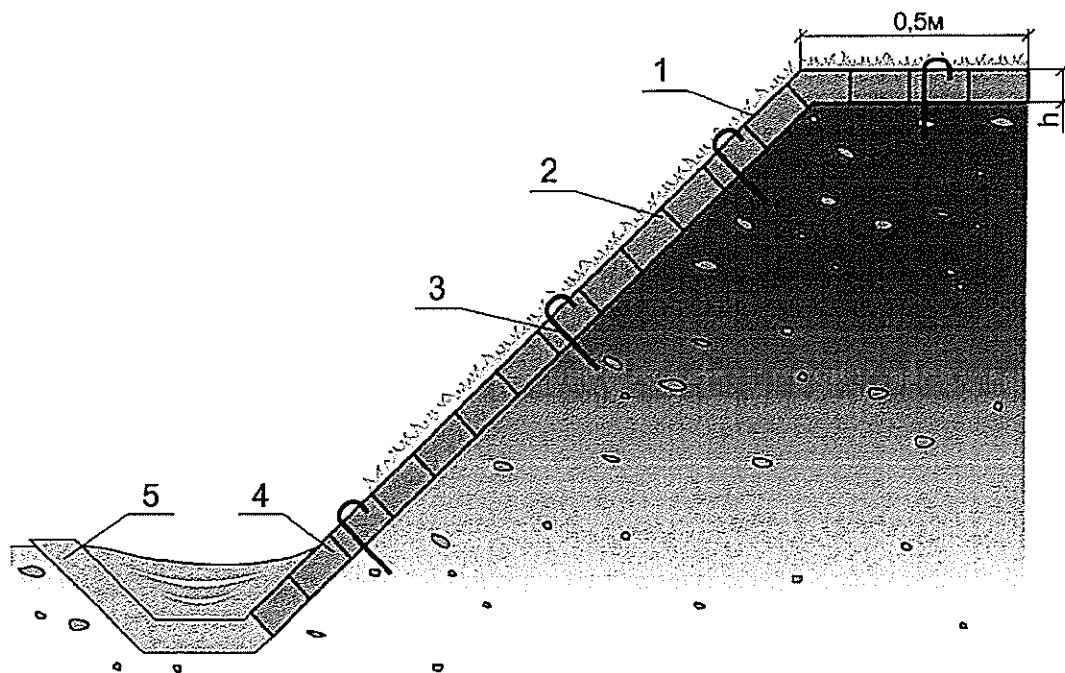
Конструкция укрепления откоса (вариант А): 1 – георешетка «ОР/ОР-СО/ОР-СН/ОР-СНО», 2 растительный грунт, 3 - анкер, 4 - бетон или щебень, 5 - водоотводной лоток
